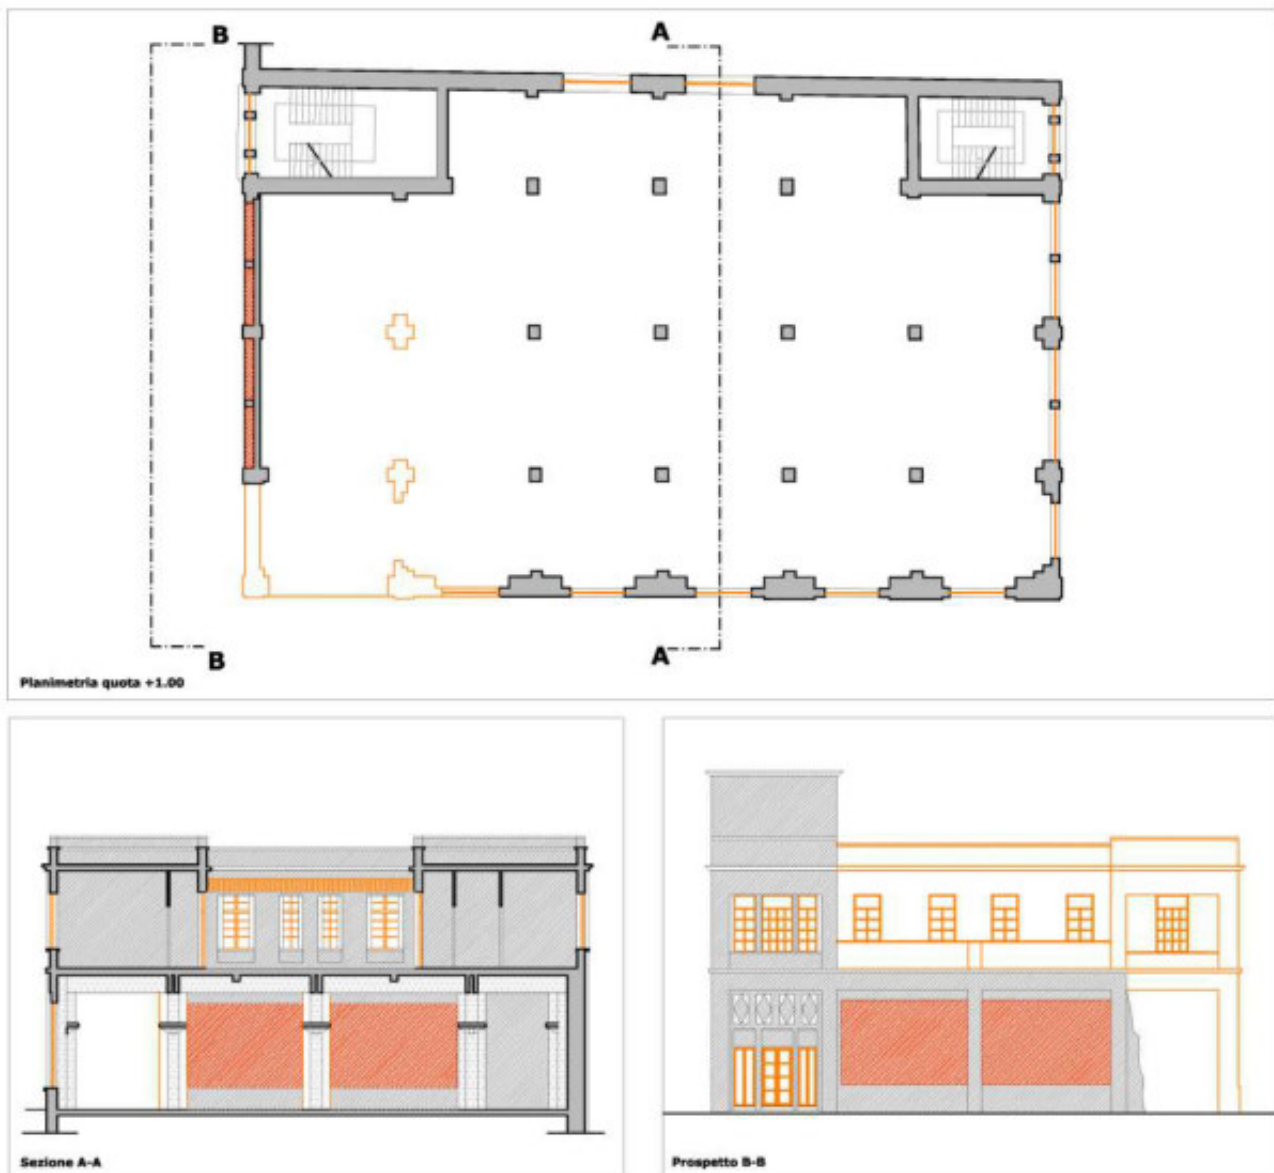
Edificio 11, Uffici e magazzini spedizioni. PFTE del progetto èreliminare approvato, 2014.
